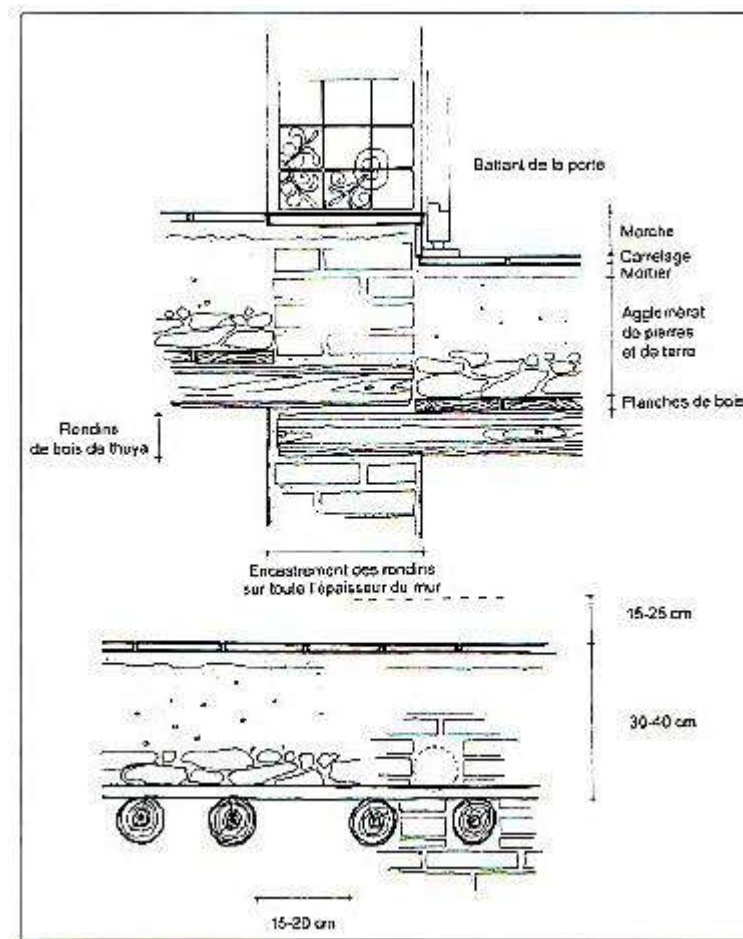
Composition du plancher (chambre, galerie) (Source : (Missoum, 2003)).
